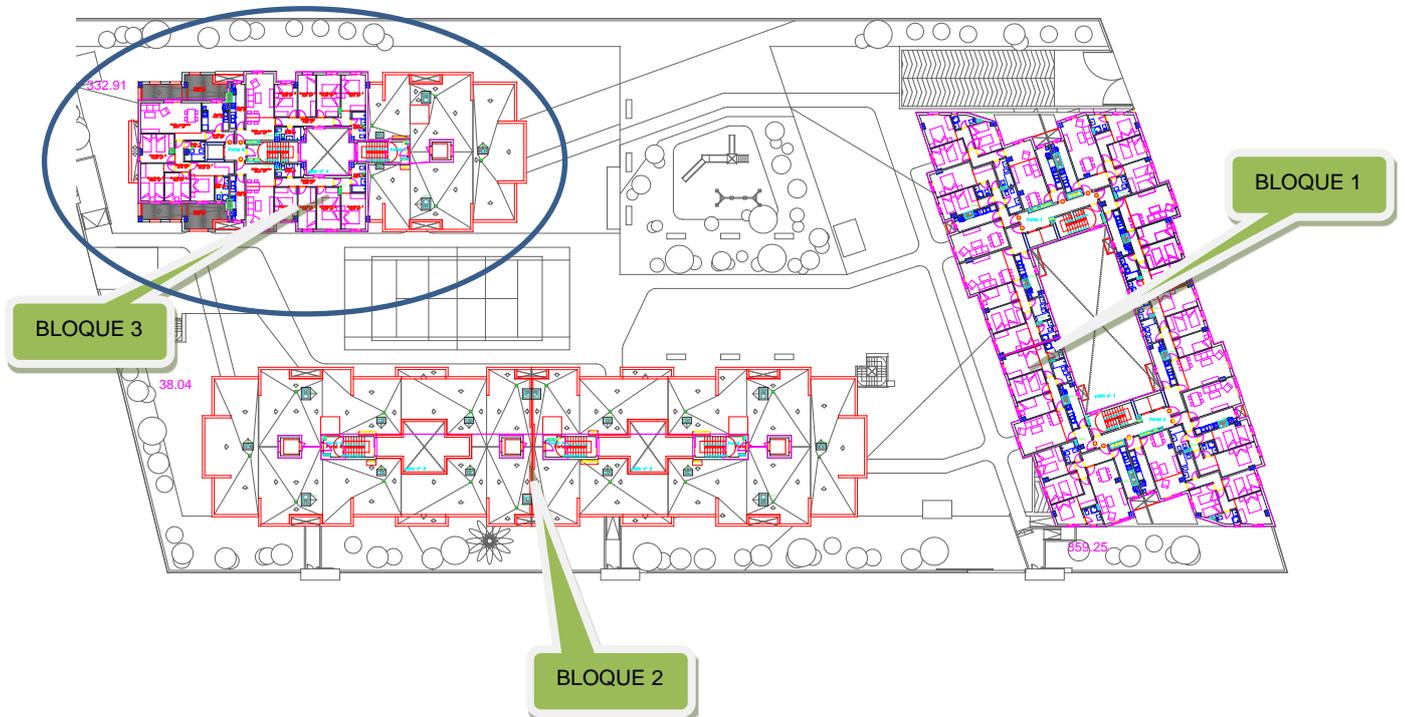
Detalle de situación de bloques, planta. Fuente Ferrovial Agromán
